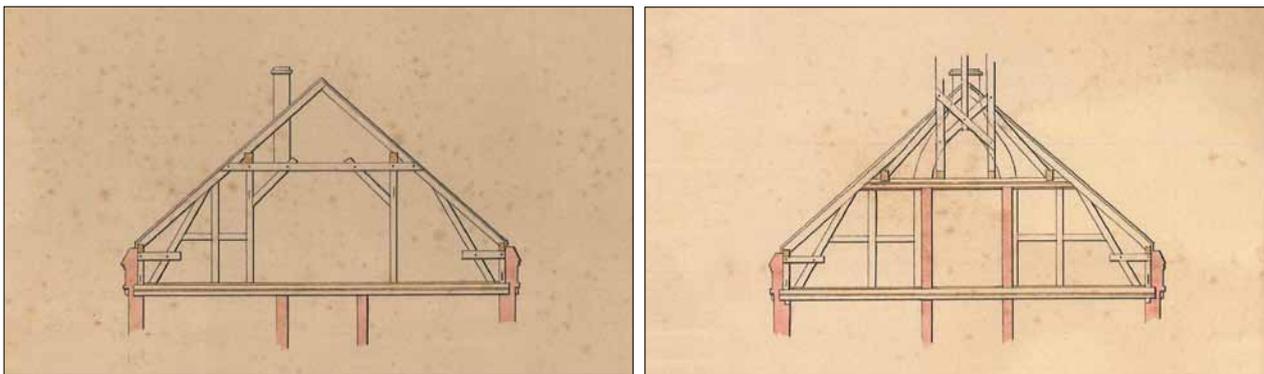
Greifswald, Baderstraße 24. Planzeichnungen für das 1879 errichtete Polizeigefängnis. Beide Darstellungen gehören zu einem größeren Blatt mit Schnitten und Grundrissen des Daches (vgl. Abb. 20). Der südliche Querschnitt (links) zeigt eine Pfetten-, der nördliche (rechts) eine Kehlbalkenkonstruktion. Zu erkennen ist auch einer der doppelten Rauchabzüge im Norddach. Abbildung: StAG Pläne B 922 (Ausschnitte)
